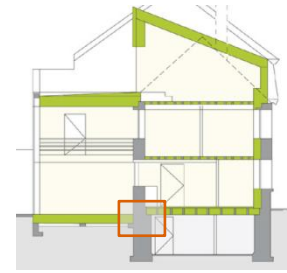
Détail de la rehausse de la façade avant, mesures en [mm]
